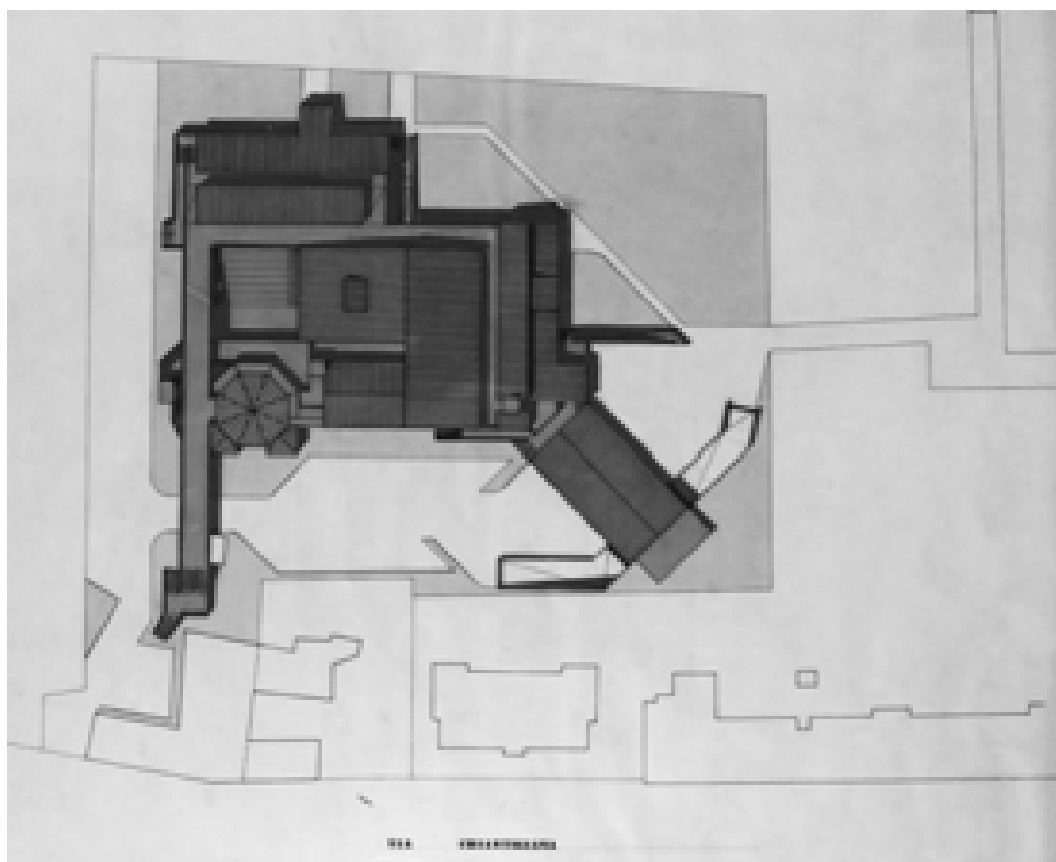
Planivolumetrico, stato futuro - 1989 (AABS-64_536)
